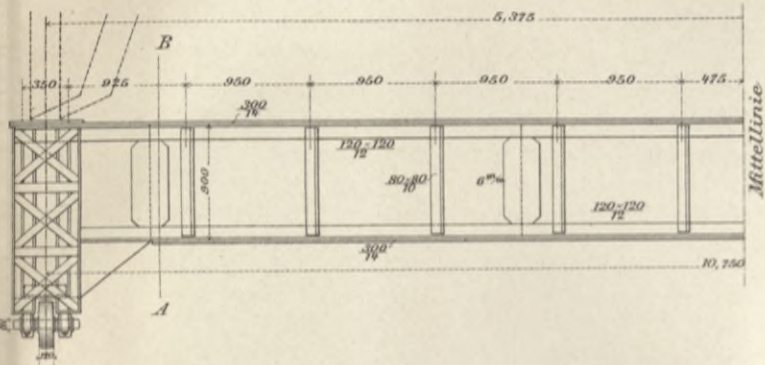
Reuss-Brücke bei Luzern. Caisson des rechtsseitigen Widerlagers.
